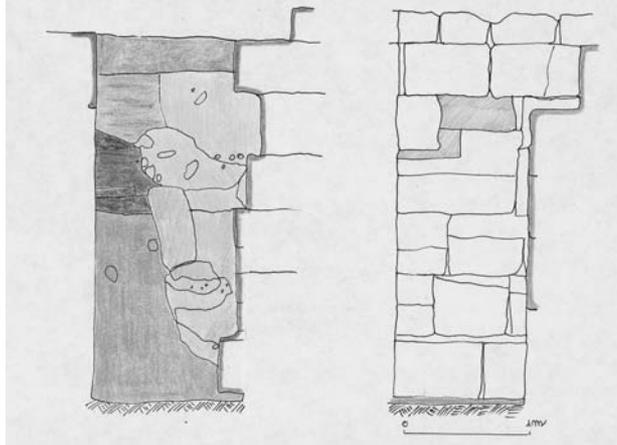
La sezione nord-sud guardando ovest e il prospetto della fondazione delle mura monte-mare di età arcaica nel loro lato interno.
